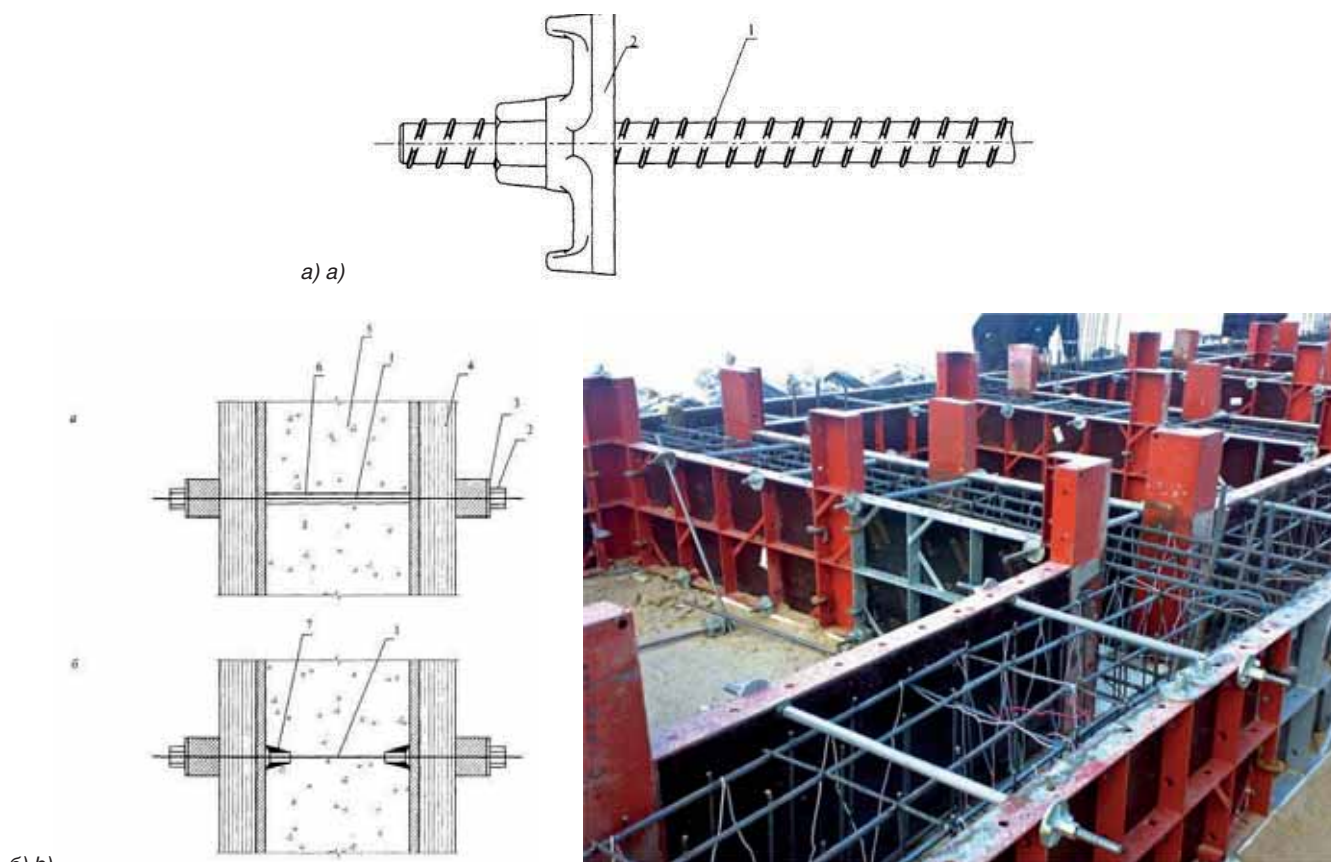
Схема крепления опалубки с использованием в качестве тяжей винтовой арматуры
